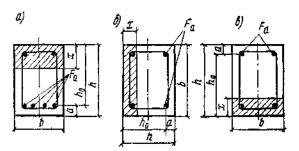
Расчетные схемы расположения сжатой зоны пространственного сечения
